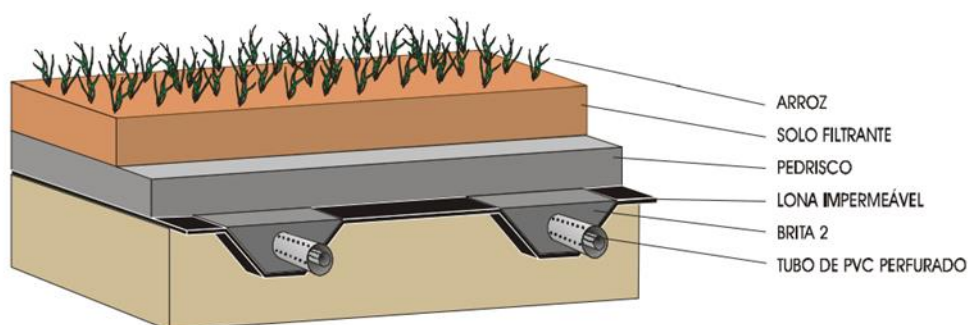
Ilustração esquemática da estrutura de *wetland* construído de tipo DHS.
